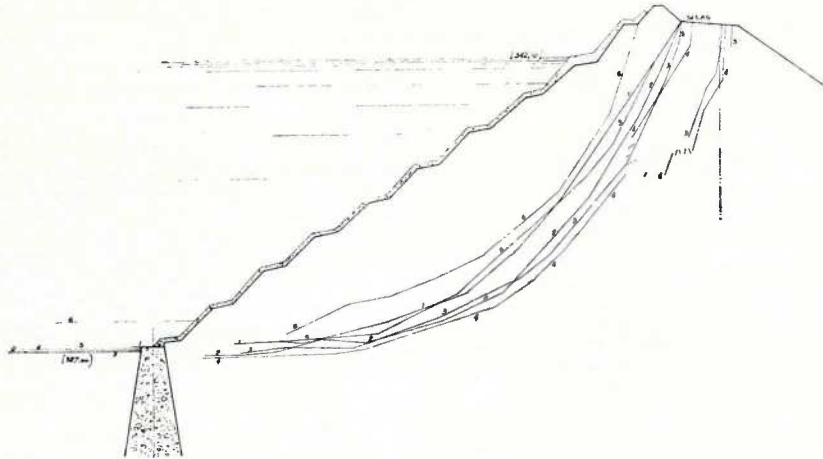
Eboulement de la digue des Charmes - 1909.
